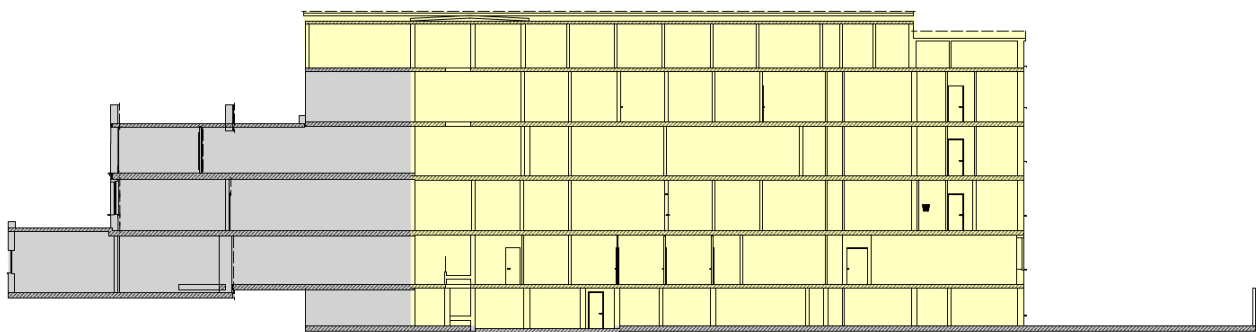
Schnitt 2-2 mit Kennzeichnung von Abbruch (gelb) und Bestand (grau) sowie des erhaltenen Gebäudeteils der KJP ohne Dachgeschoss
